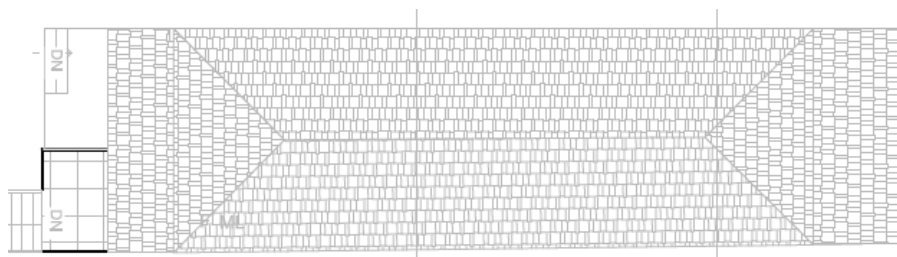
Planta da cobertura do edifício da rua de Vilar. Fonte: RIELZA.
